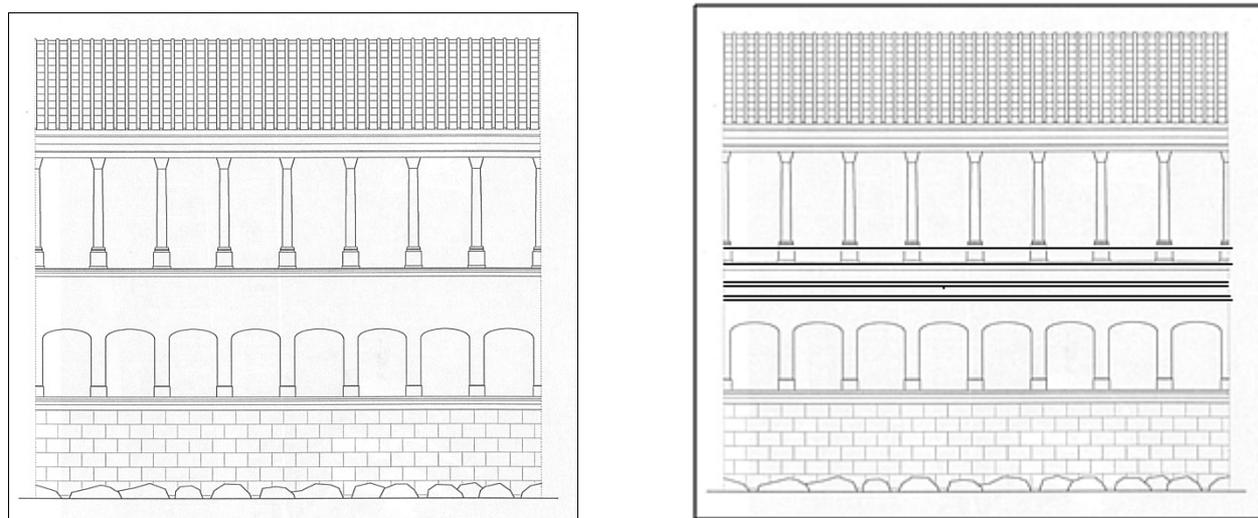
Proposition d'élévation de la façade maritime. A gauche version CEDAC. A droite version 2017 : pour approcher au plus près la lampe Deneauve je propose un entablement au dessus des arcatures du sous-sol surmonté d'un mur attique faisant main courante, intégrant les socles de la colonnade (voir les images de fin qui ont influencé cette proposition).
